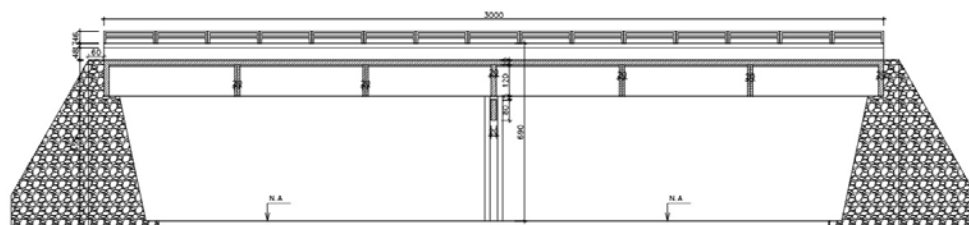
Corte longitudinal na geometria original da ponte 3.
